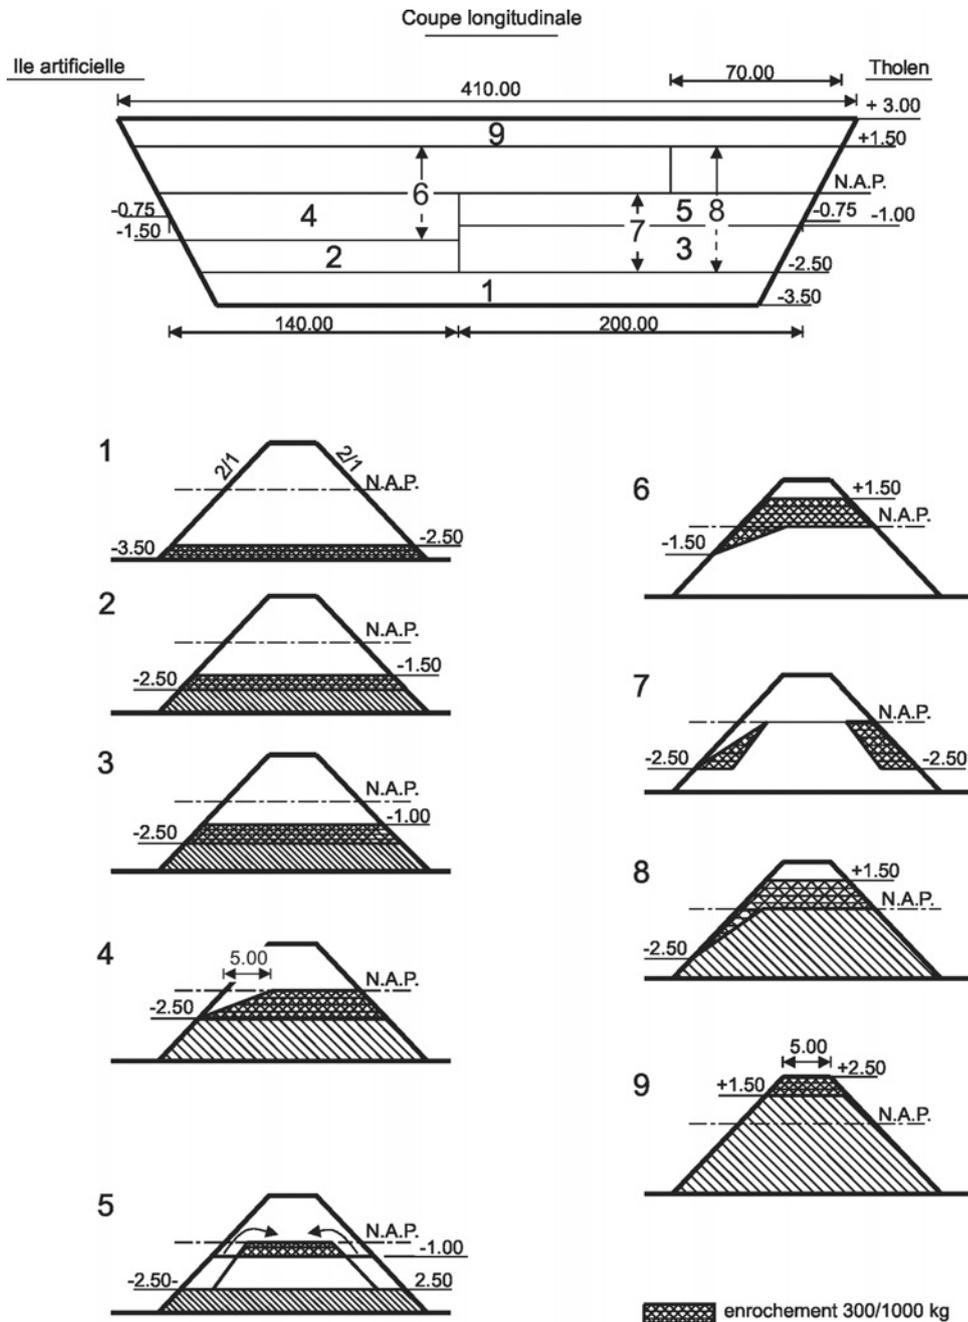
Élévation de la fermeture de Tholense Gat, d'une hauteur située 3.5 m sous le niveau moyen de la mer jusqu'à une hauteur située 3 m au-dessus du niveau moyen de la mer; N.A.P. = niveau de référence local, approximativement égal au niveau moyen de la mer
